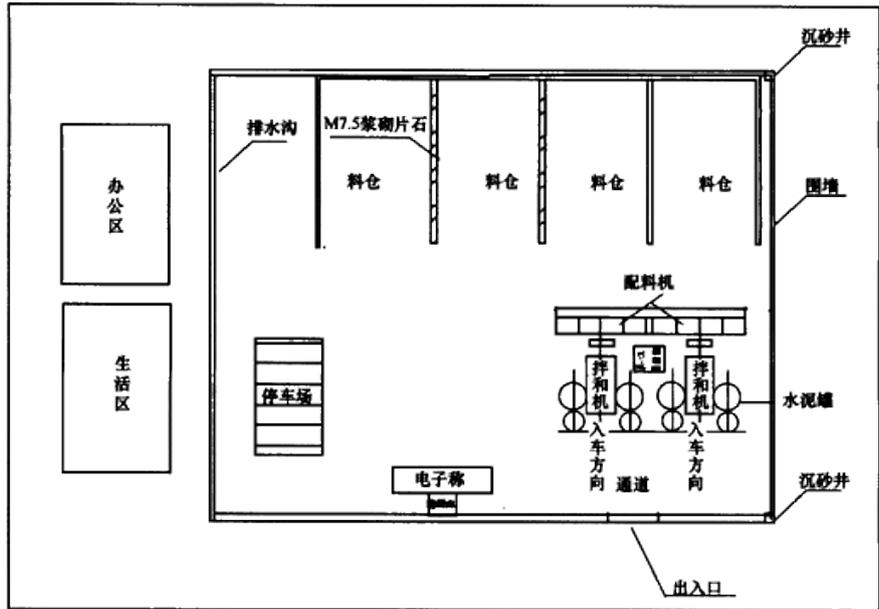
B420163-1 某水泥混凝土拌和站平面布置示意图
